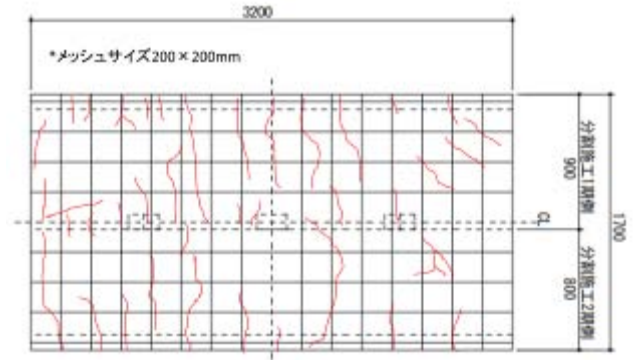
分割施工試験体 No.3 載荷前のひび割れ (下面)
